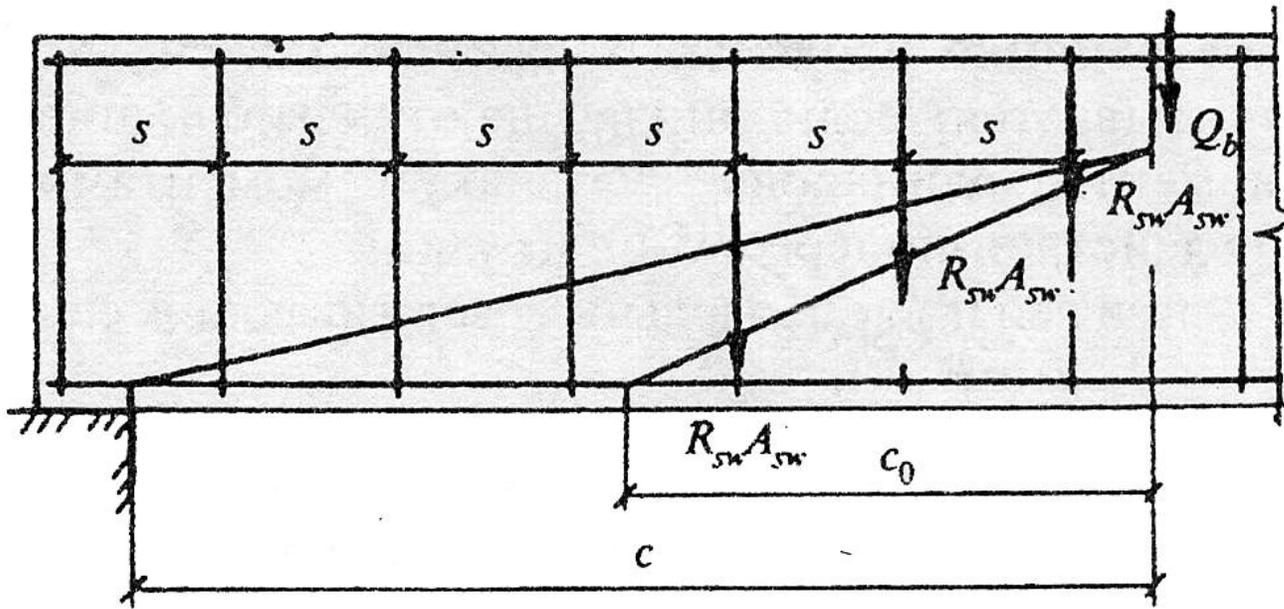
Схема усилий и армирования при проверке сечения на прочность от действия поперечной силы
